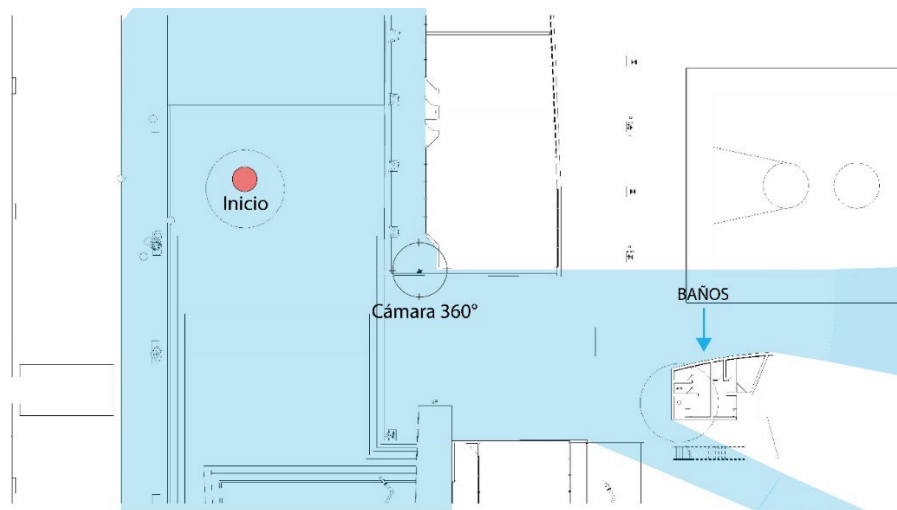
Elaboración propia. Plano de primera planta del edificio con posición de cámara 360\*.
